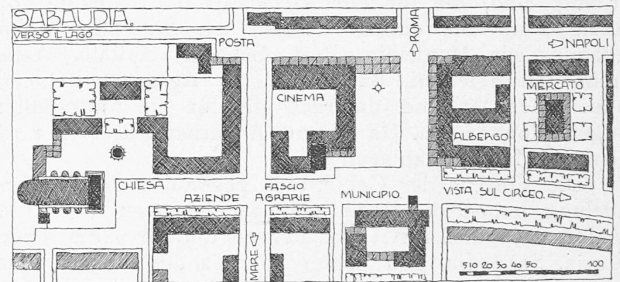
Das Zentrum von Sabaudia. — Lageplan 1:5000.
